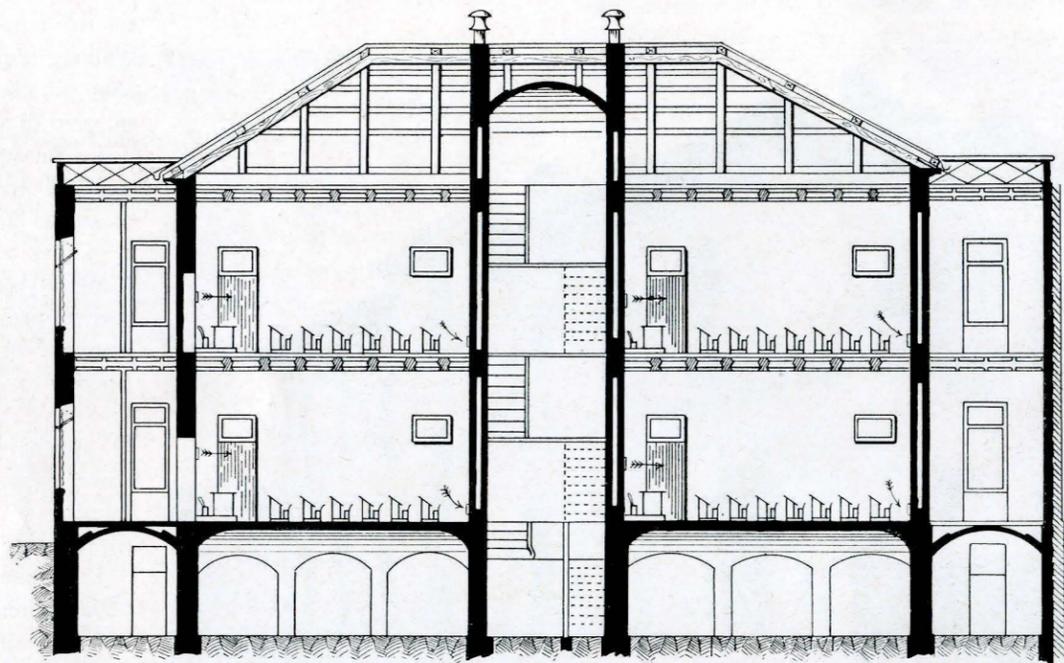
Sezione longitudinale lungo la linea E F (scala 1:200).
